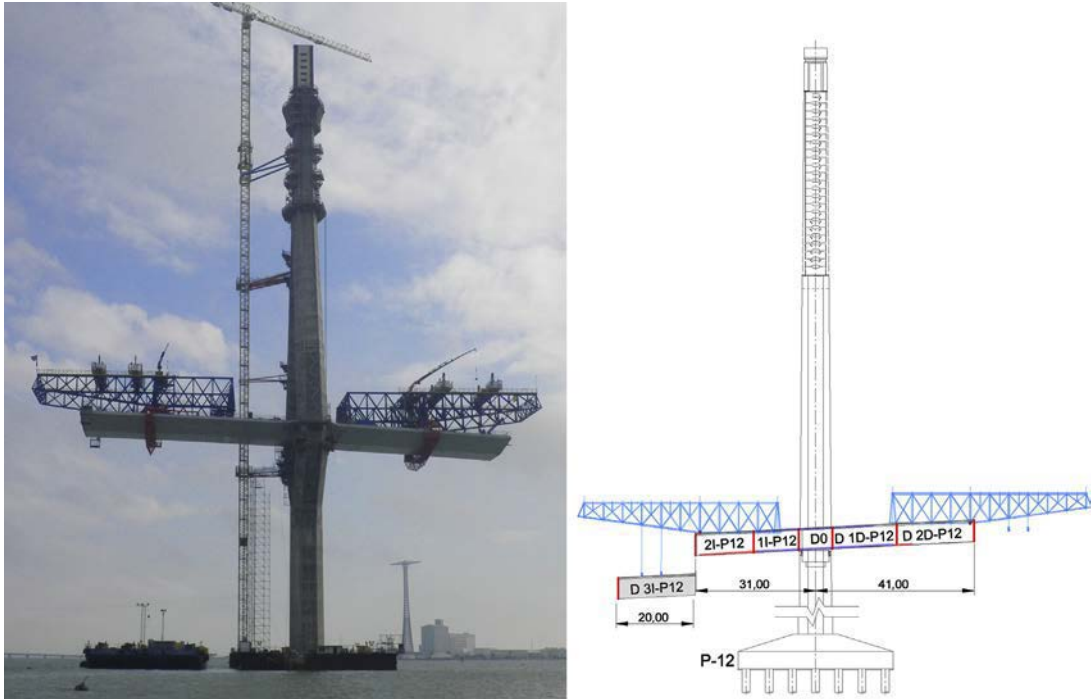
Fase de construcción del tablero previa a la instalación de tirantes.
